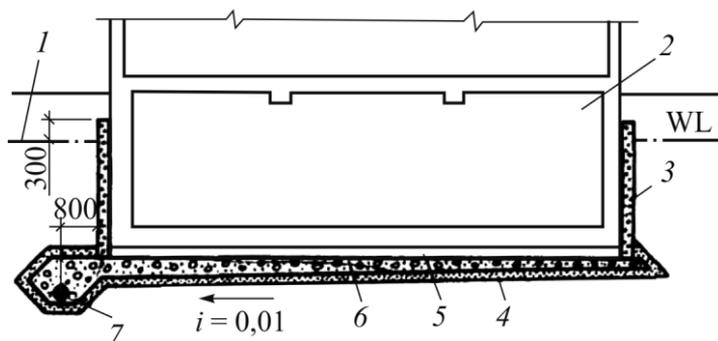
Пластовый дренаж: 1 – уровень подземных вод; 2 – защищаемое заглубленное помещение; 3 – пристенный дренаж; 4 – песчаный слой; 5 – защитное покрытие щебеночного слоя; 6 – песчано-гравийный или щебеночный слой; 7 – труба
